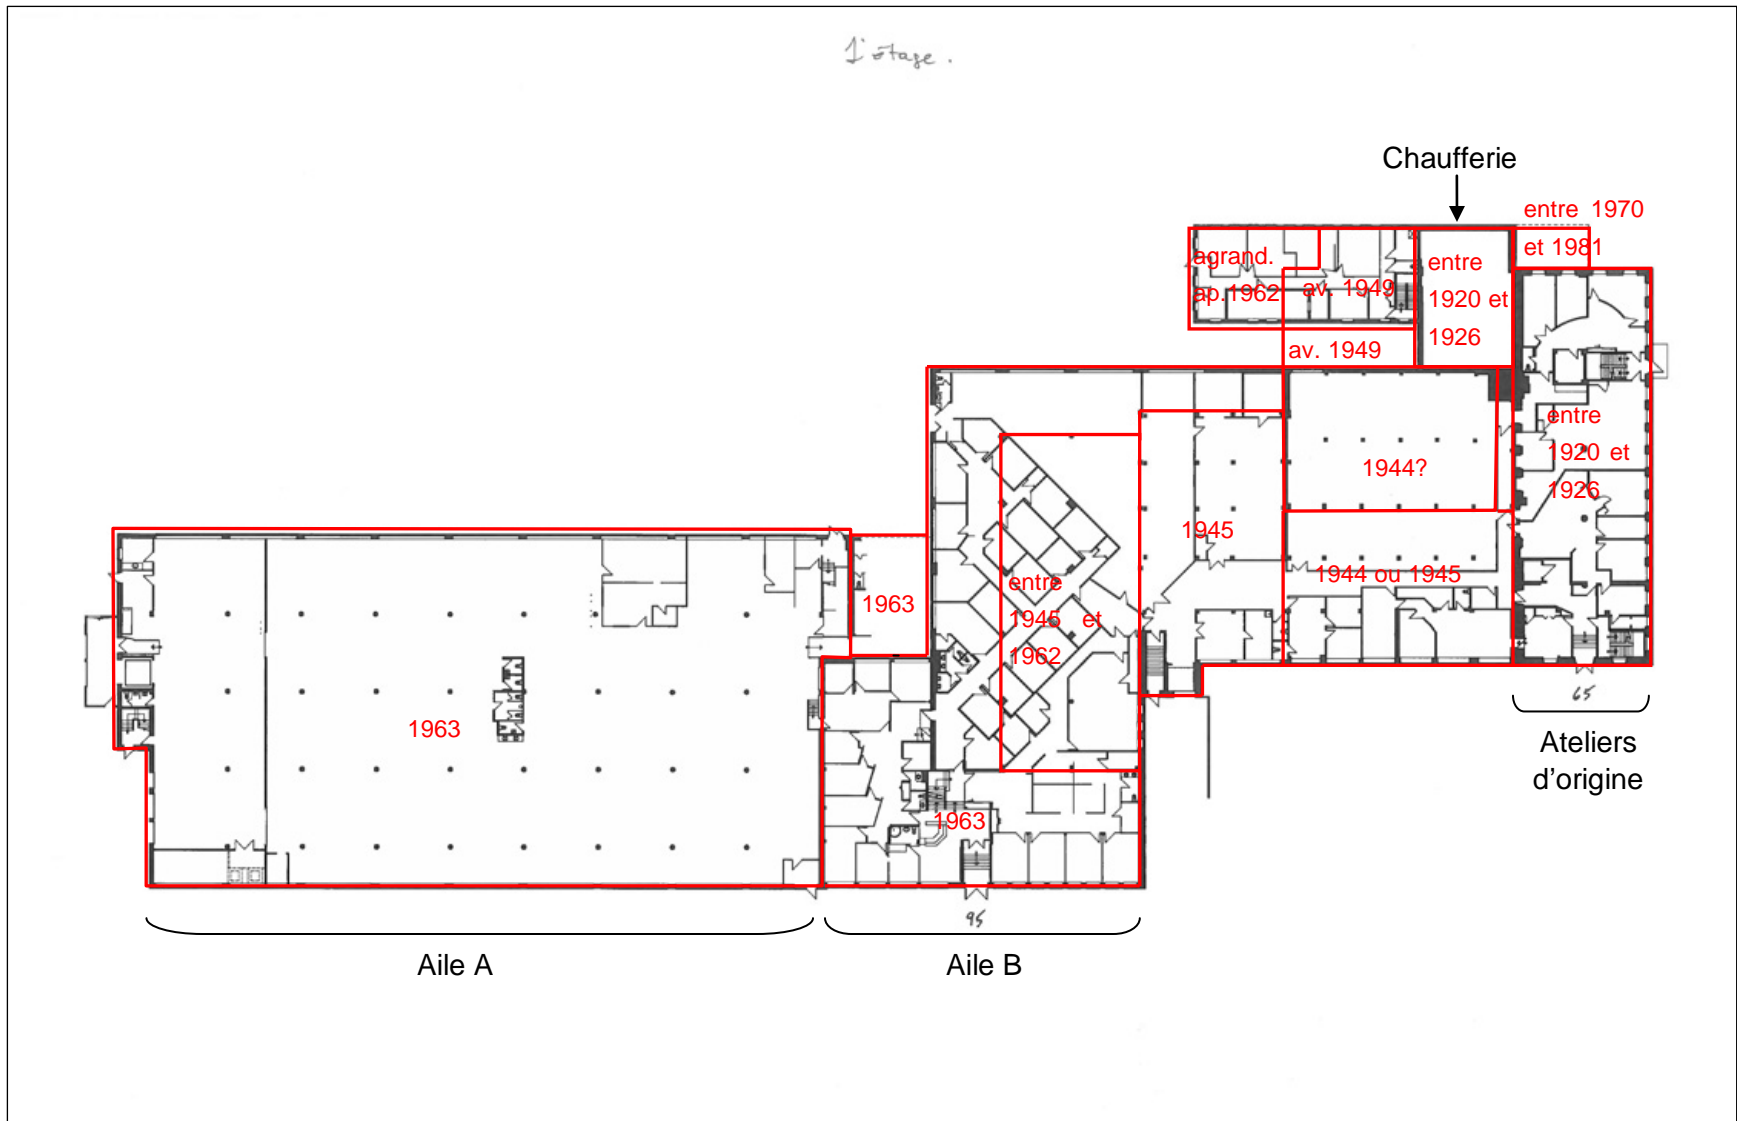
Plan du rez-de-chaussée avec le découpage approximatif et les dates de construction des différentes sections du bâtiment. Source du plan : Anonyme, plan du 1<sup>er</sup> étage, sans date, fourni par la compagnie 9227-7797 Québec inc. (modifié par l'auteure).
